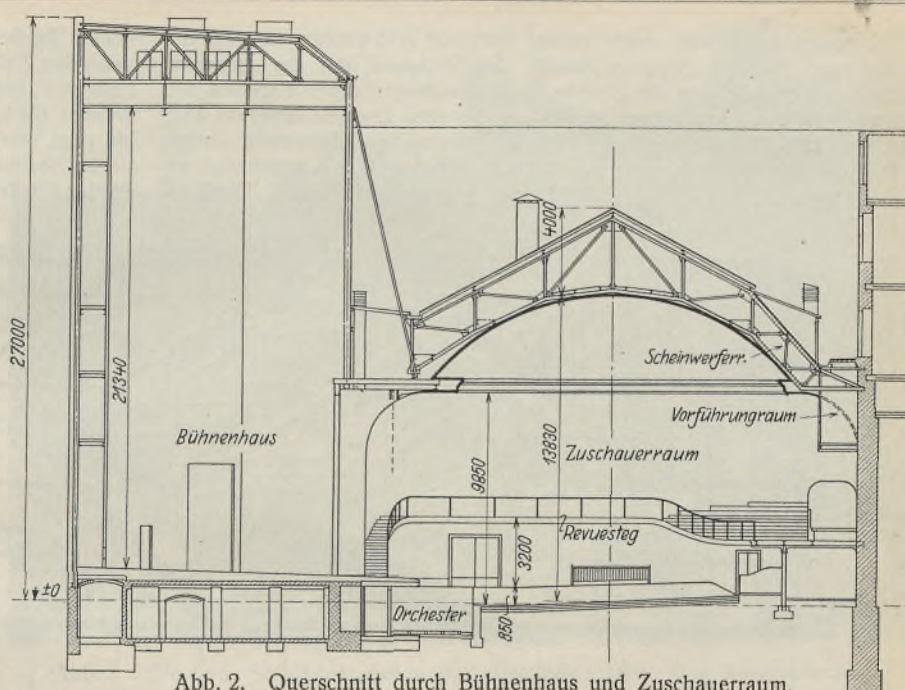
Querschnitt durch Bühnenhaus und Zuschauerraum.
